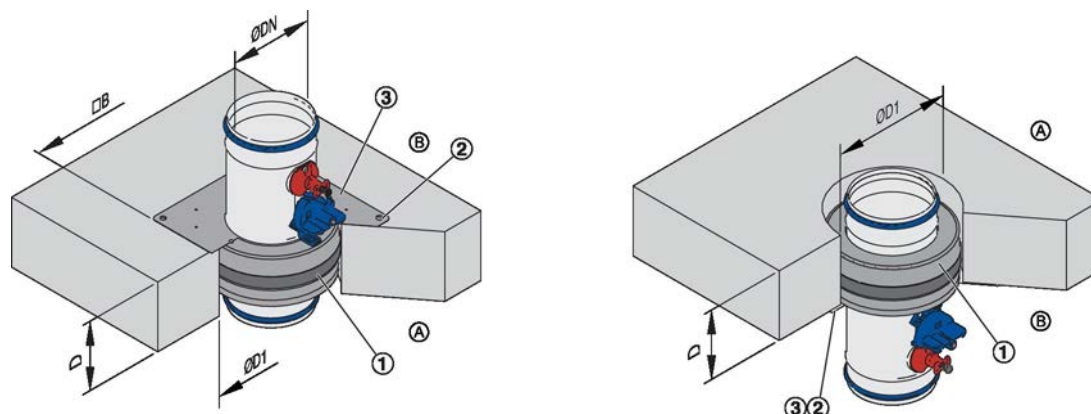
Montage à sec sans mortier en plafond plein, suspendu ou à la verticale
